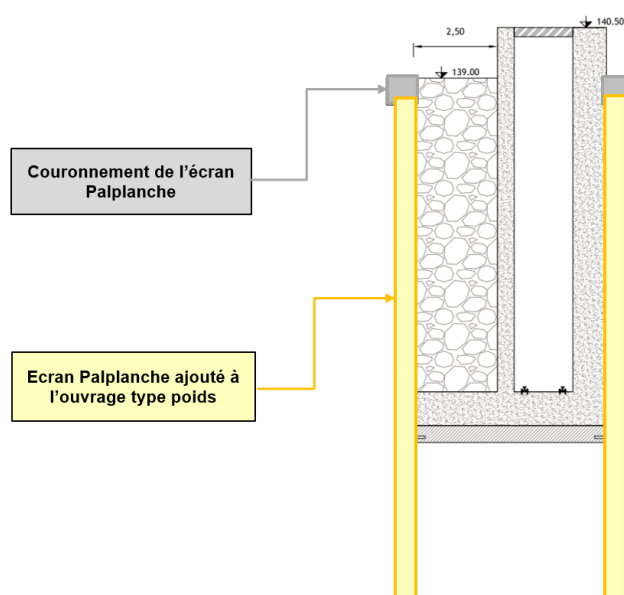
Assemblage du rideau palplanche de soutènement provisoire à l'ouvrage principal type poids
